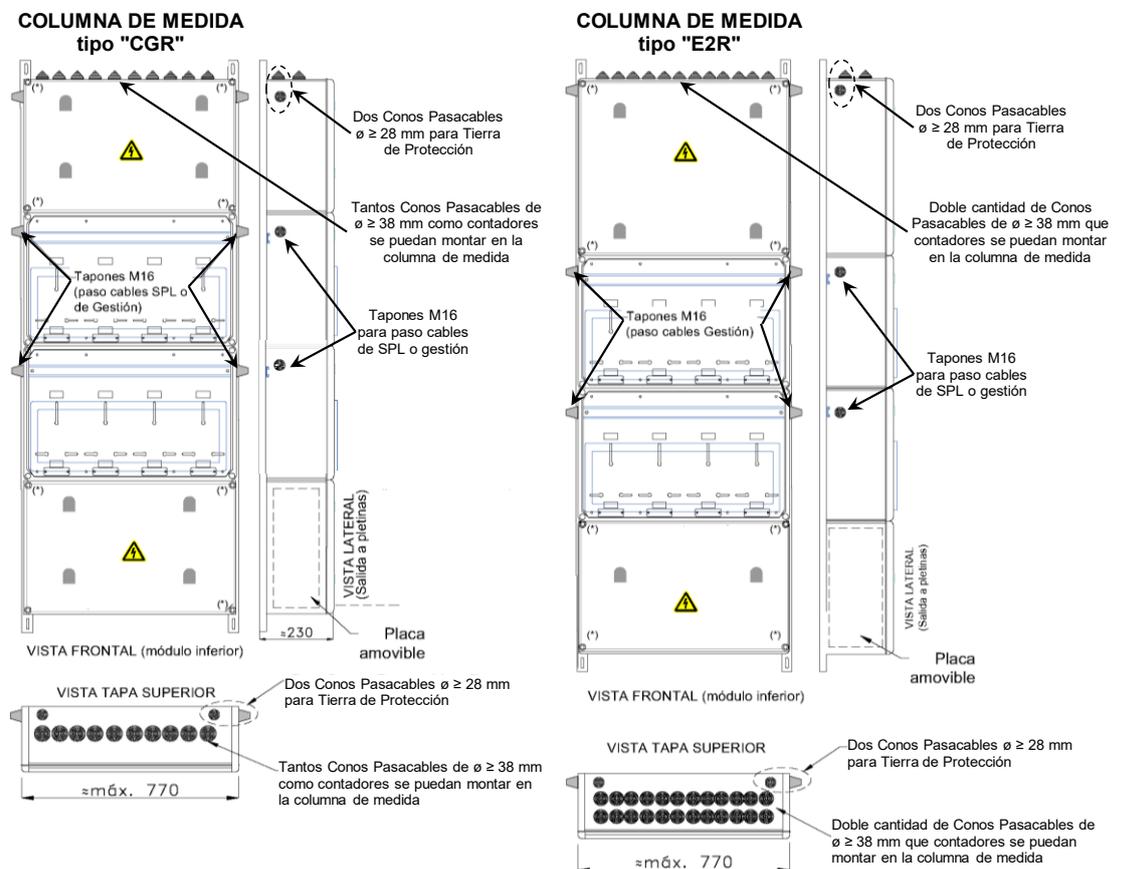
Conos pasacables y Tapones en Columnas de Medida
